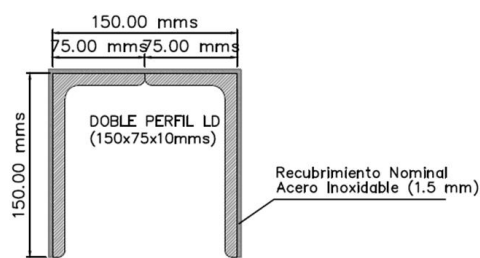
Sección prevista para el dintel en el Proyecto de Construcción.
